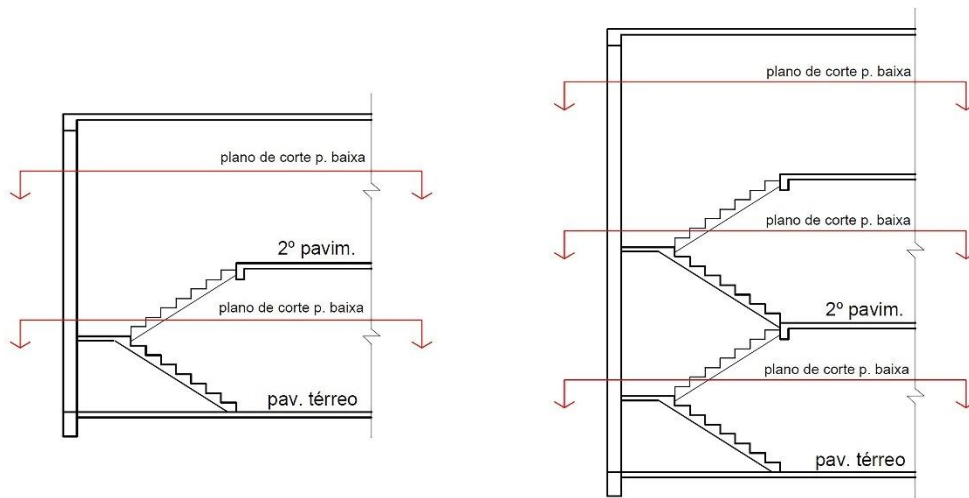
Escadas: planos de corte das plantas baixas. Fonte: autor
